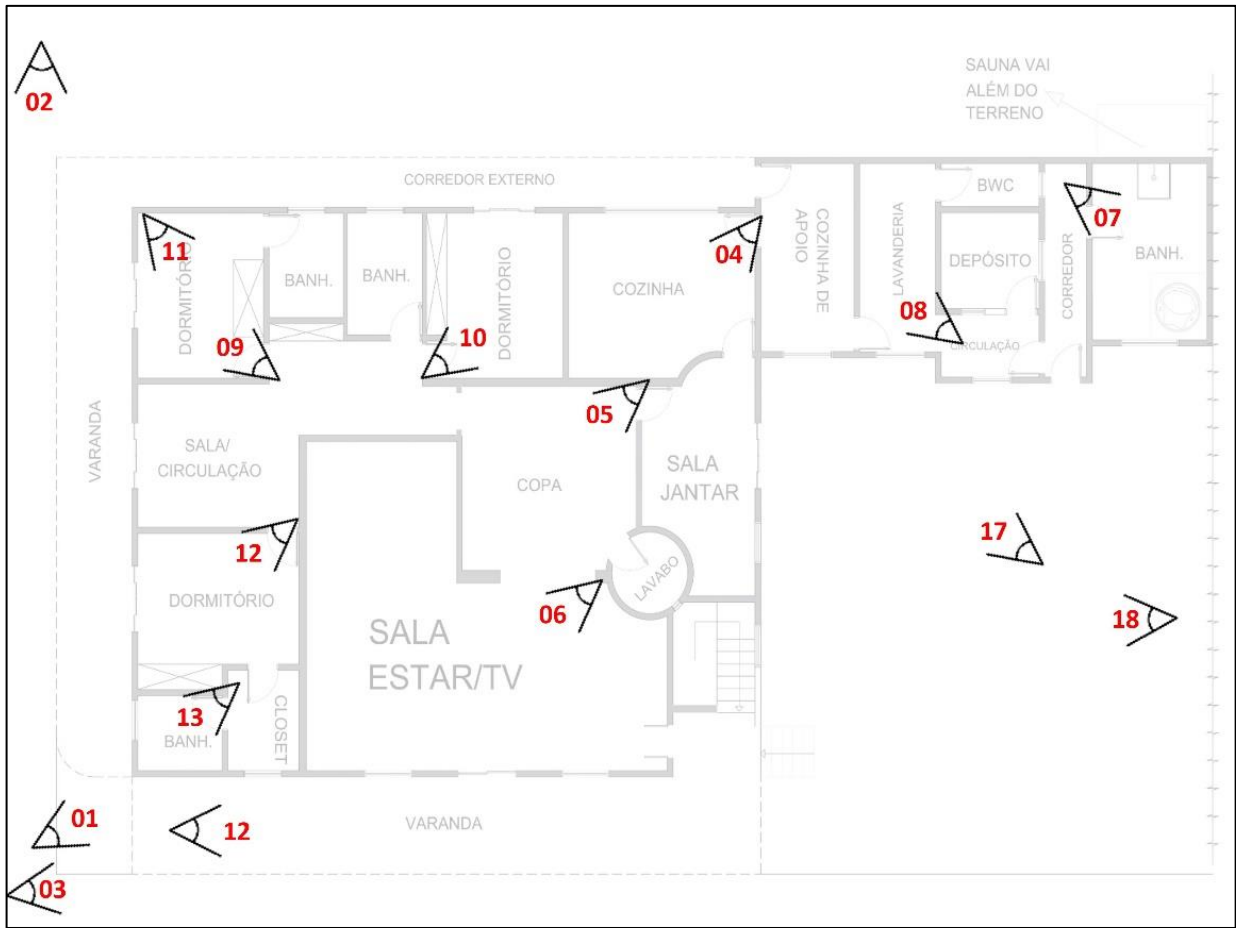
Croqui do imóvel avaliando: pavimento superior (Fonte: o Autor)
